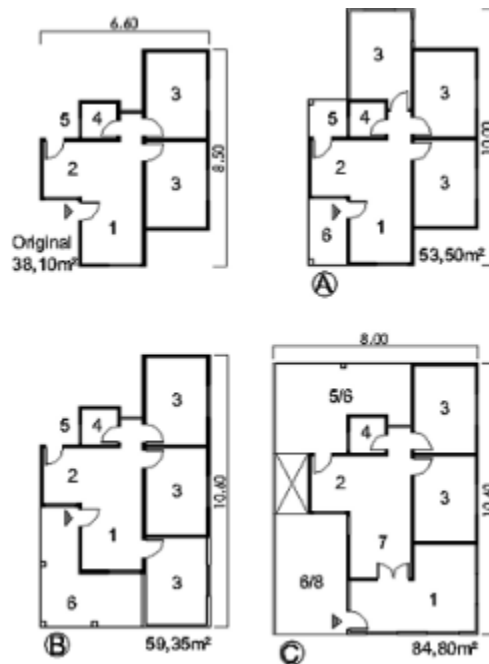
Planta baixa com detalhes do embrião sala-cozinha-banheiro-serviço do Projeto nº XIV proposto por Brandão (2006).
